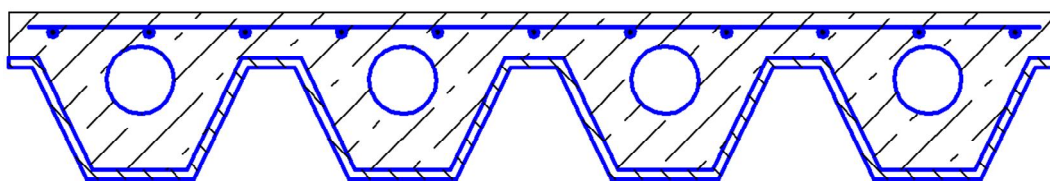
Конструктивное решение плиты перекрытия с внешним армированием
